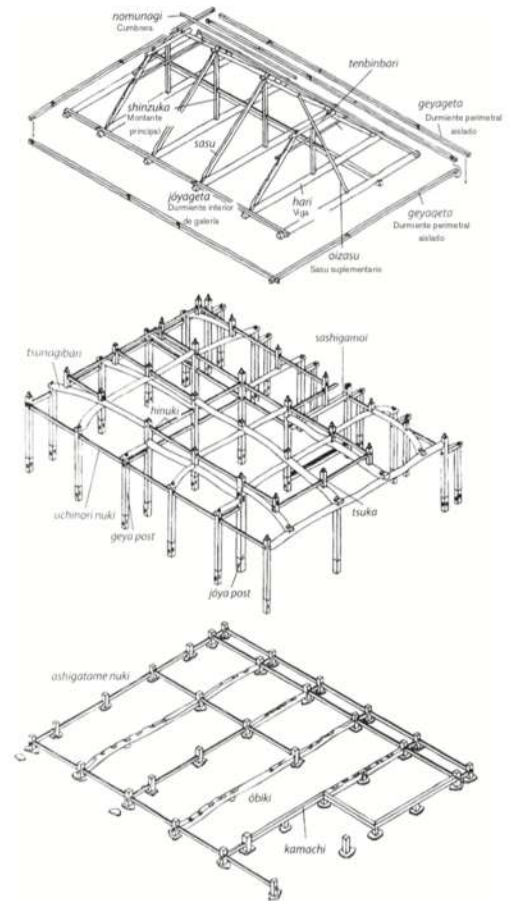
Axonometría, sistema constructivo de la casa japonesa. Fuente: O4/Arquitecturas reversibles de Japón. Las casa de Shirakawa-go. (2017)
